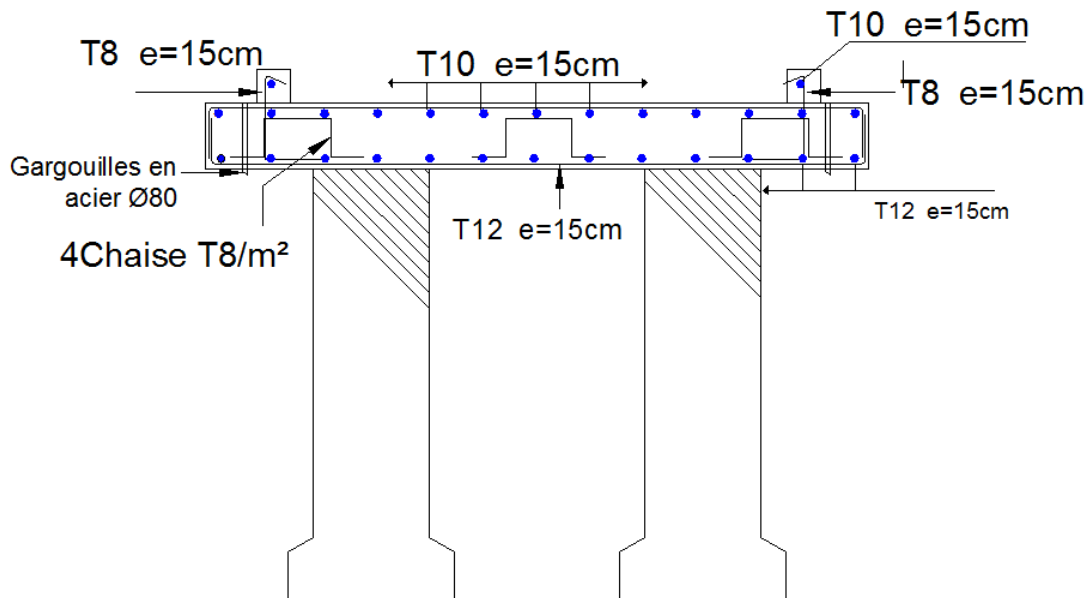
Ferrailage de dalle en BA (Hourdis)
